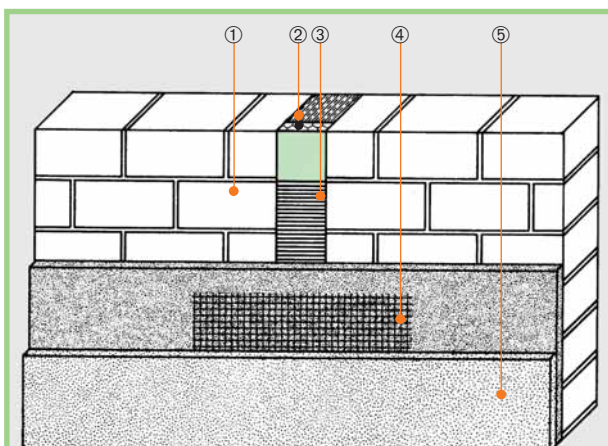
Architrave della finestra nella muratura da isolare termicamente; stesura orizzontale dello strato adesivo per l'intonaco.
